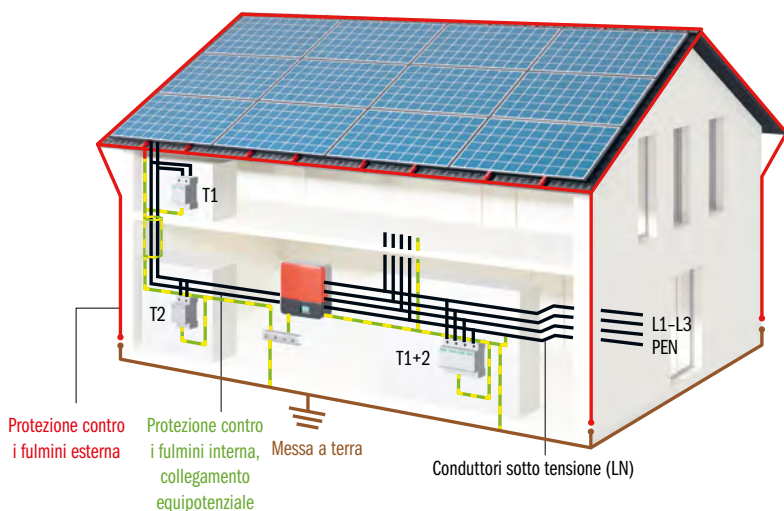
Variante con protezione esterna dai fulmini / Esempio dal libro «Impianti fotovoltaici» (Photovoltaikanlagen) di Christof Bucher (edizione Faktor, 2025)
